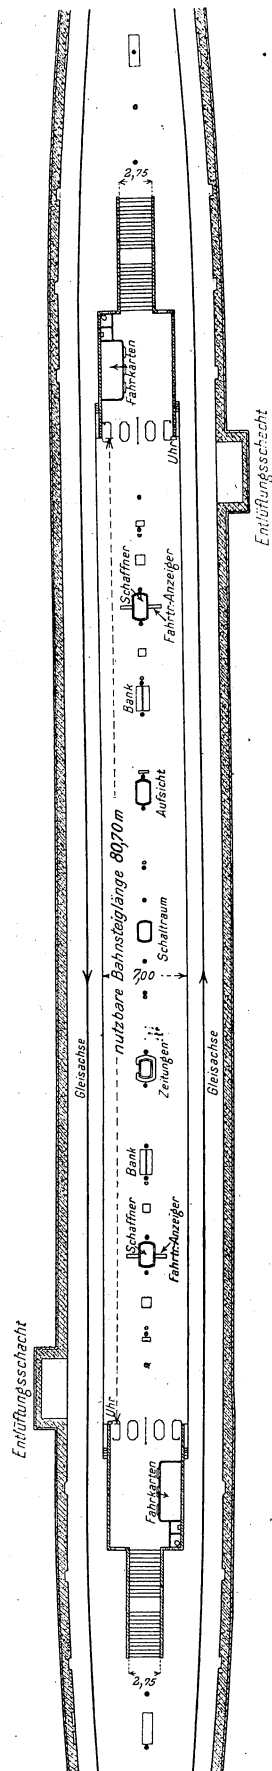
Normale Haltestelle mit einer Treppe (Grundriß). Maßstab 1 : 625.
